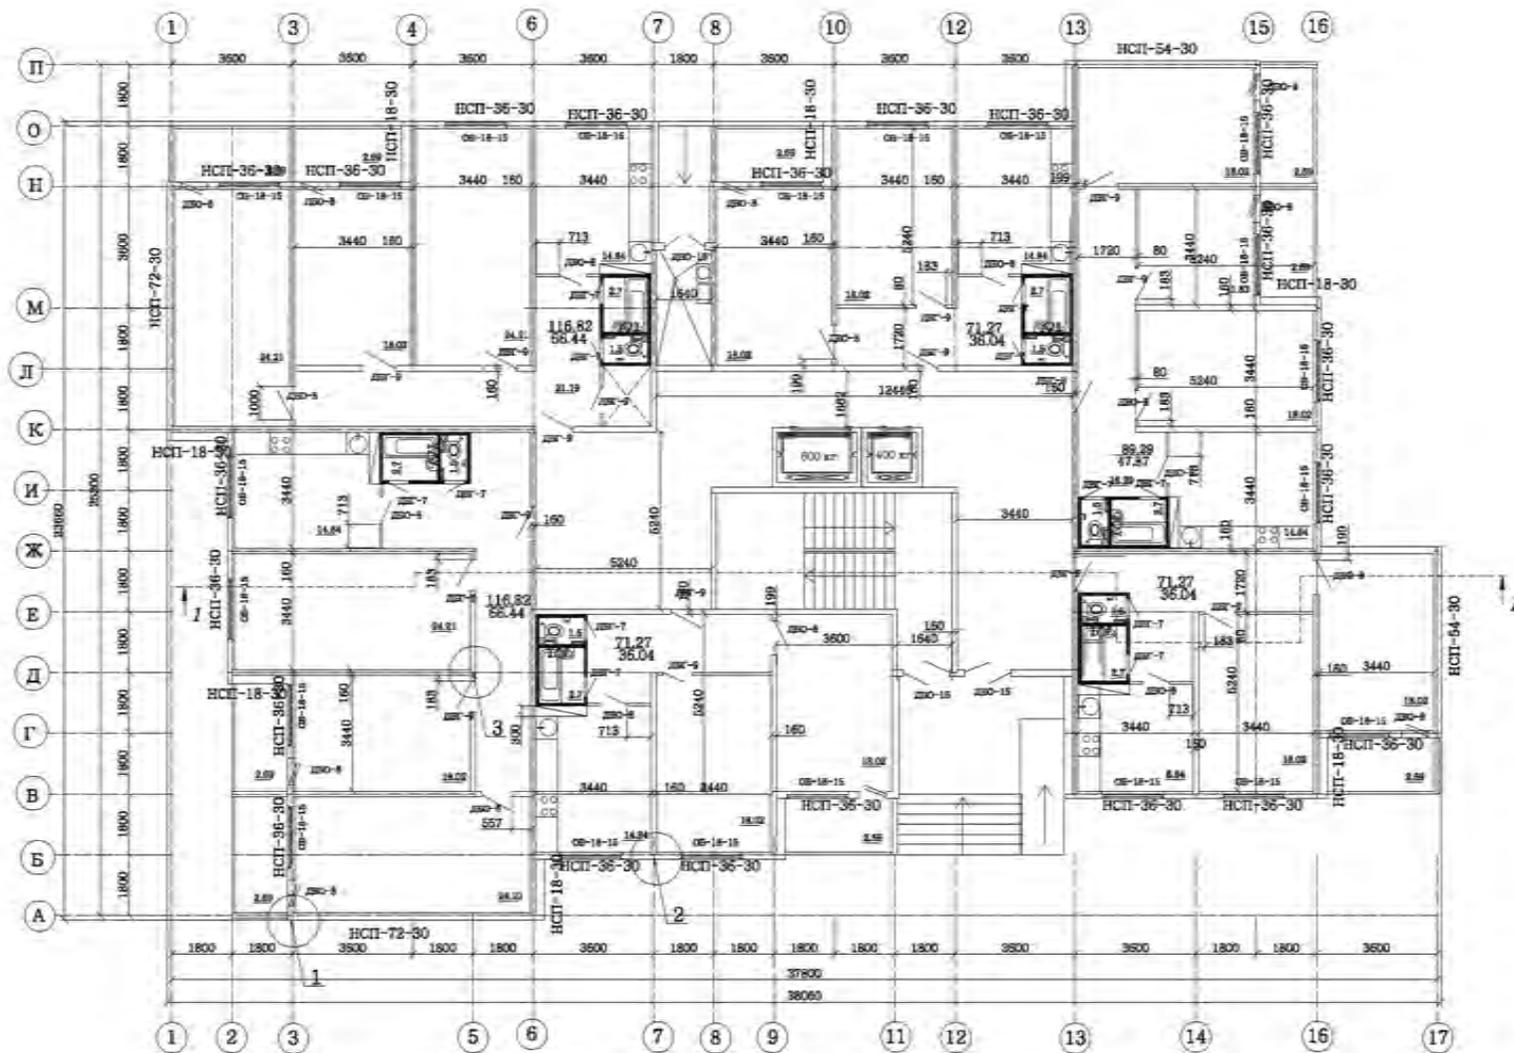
Точечная планировочная схема (односекционная). План 1-го этажа
